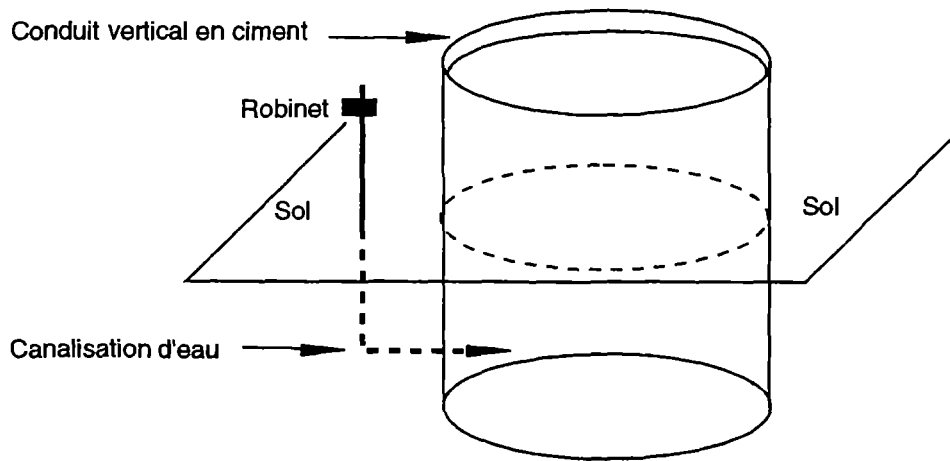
Coupe d'un point d'eau public de Nouakchott
